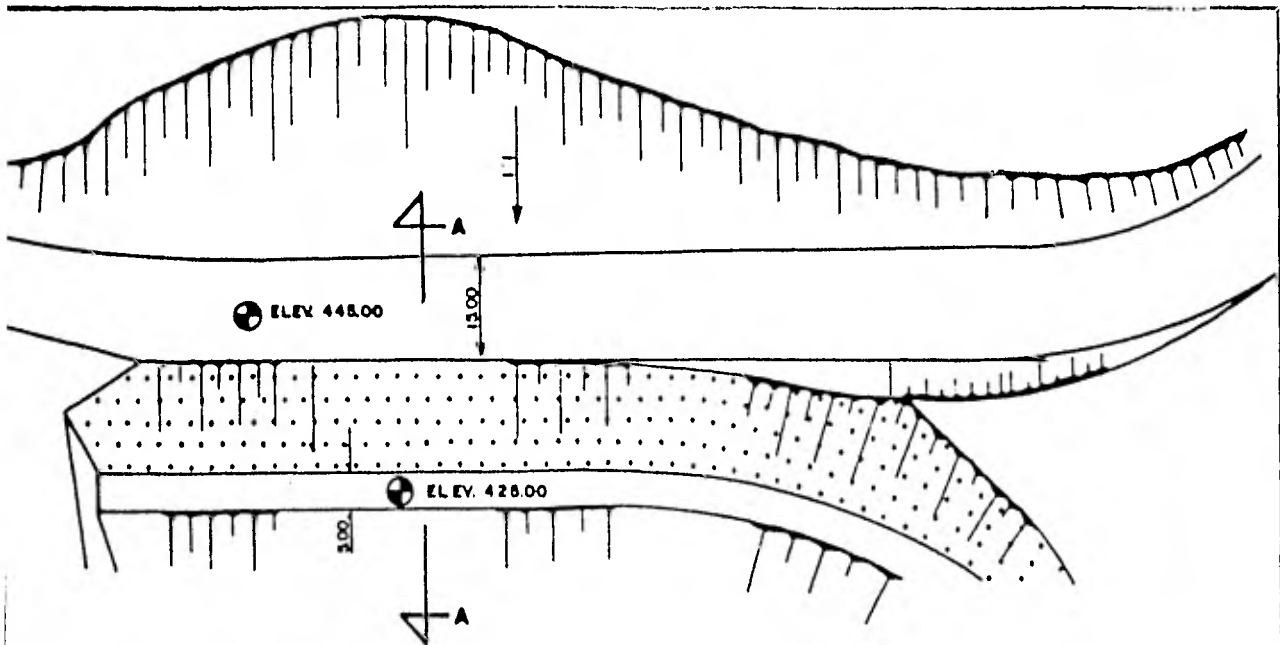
TRATAMIENTO DE TALUD LADO ORIENTE DE ELEVACION 445.00 a 425.00
